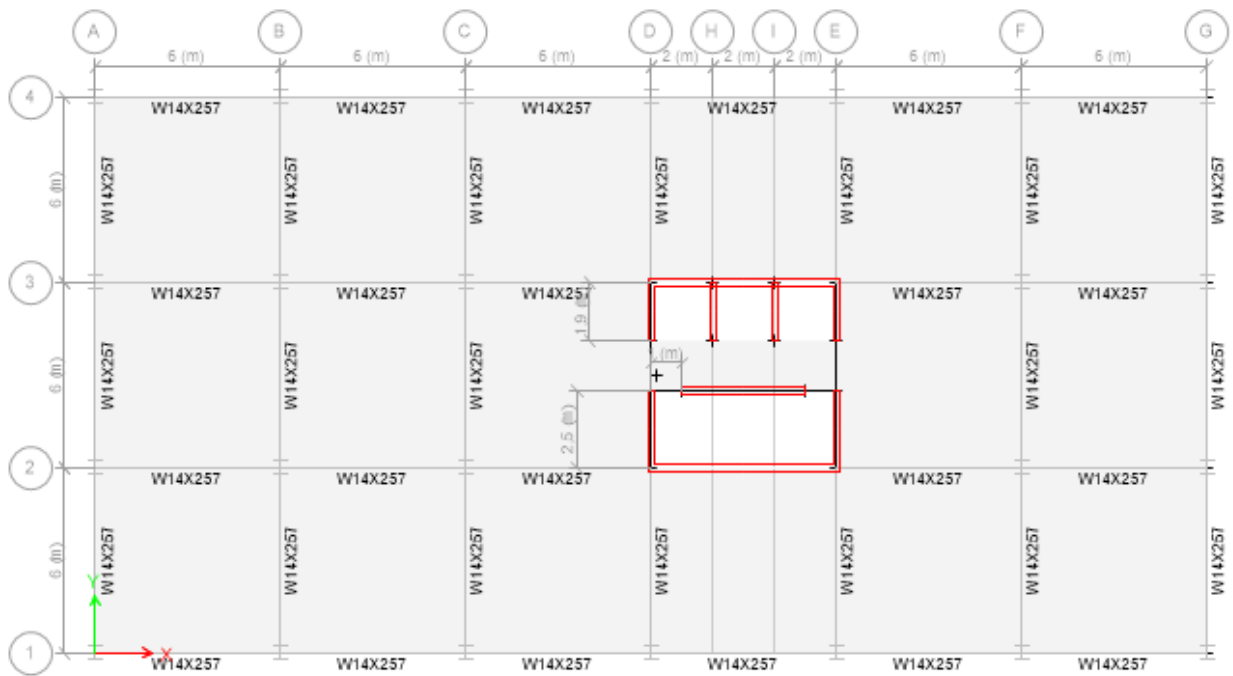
14: Vista en planta de las vigas correspondiente a los pisos 7-12, edificio tipo C.
